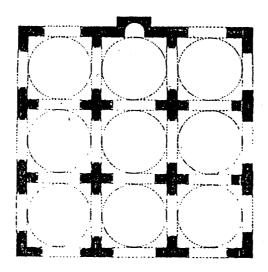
مسقط أفقي لجامع السنانية ببولاق بالقاهرة (عن : Brandenburg).
